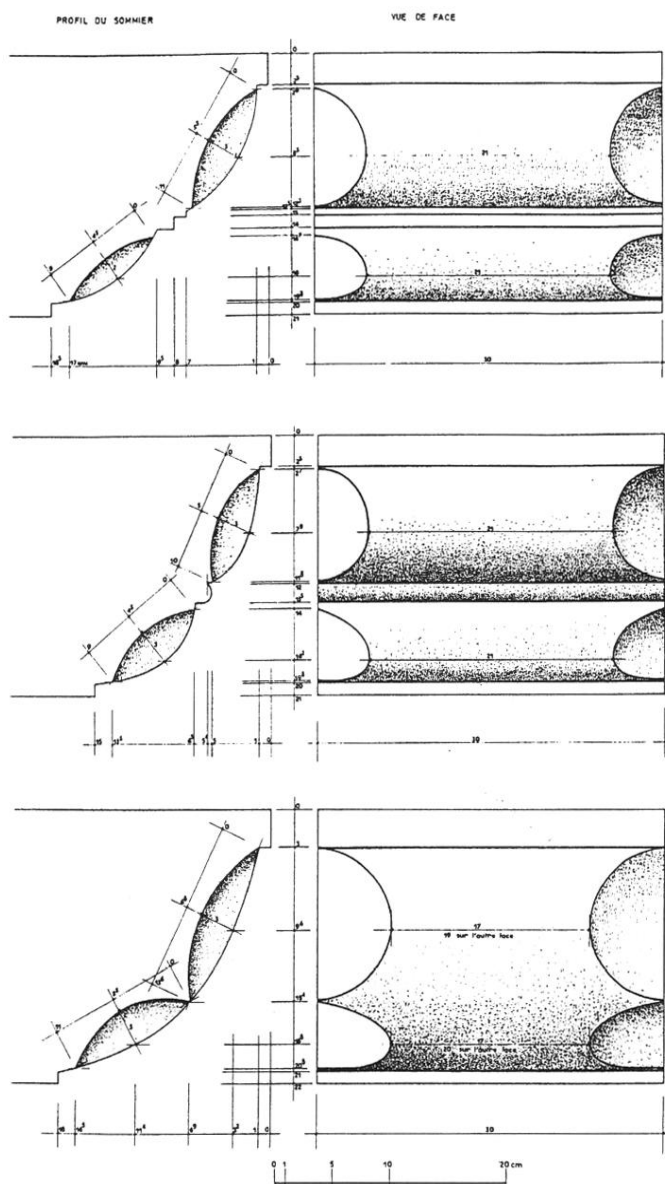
Rez-de-chaussée au nord- Grande salle- Poteaux 1 à 4. Profil des moulures des sommiers (de haut en bas : poteau 1, 2 et 3 puis 4). (Dessin H. Rezza Doc. C.R.M.H.)
